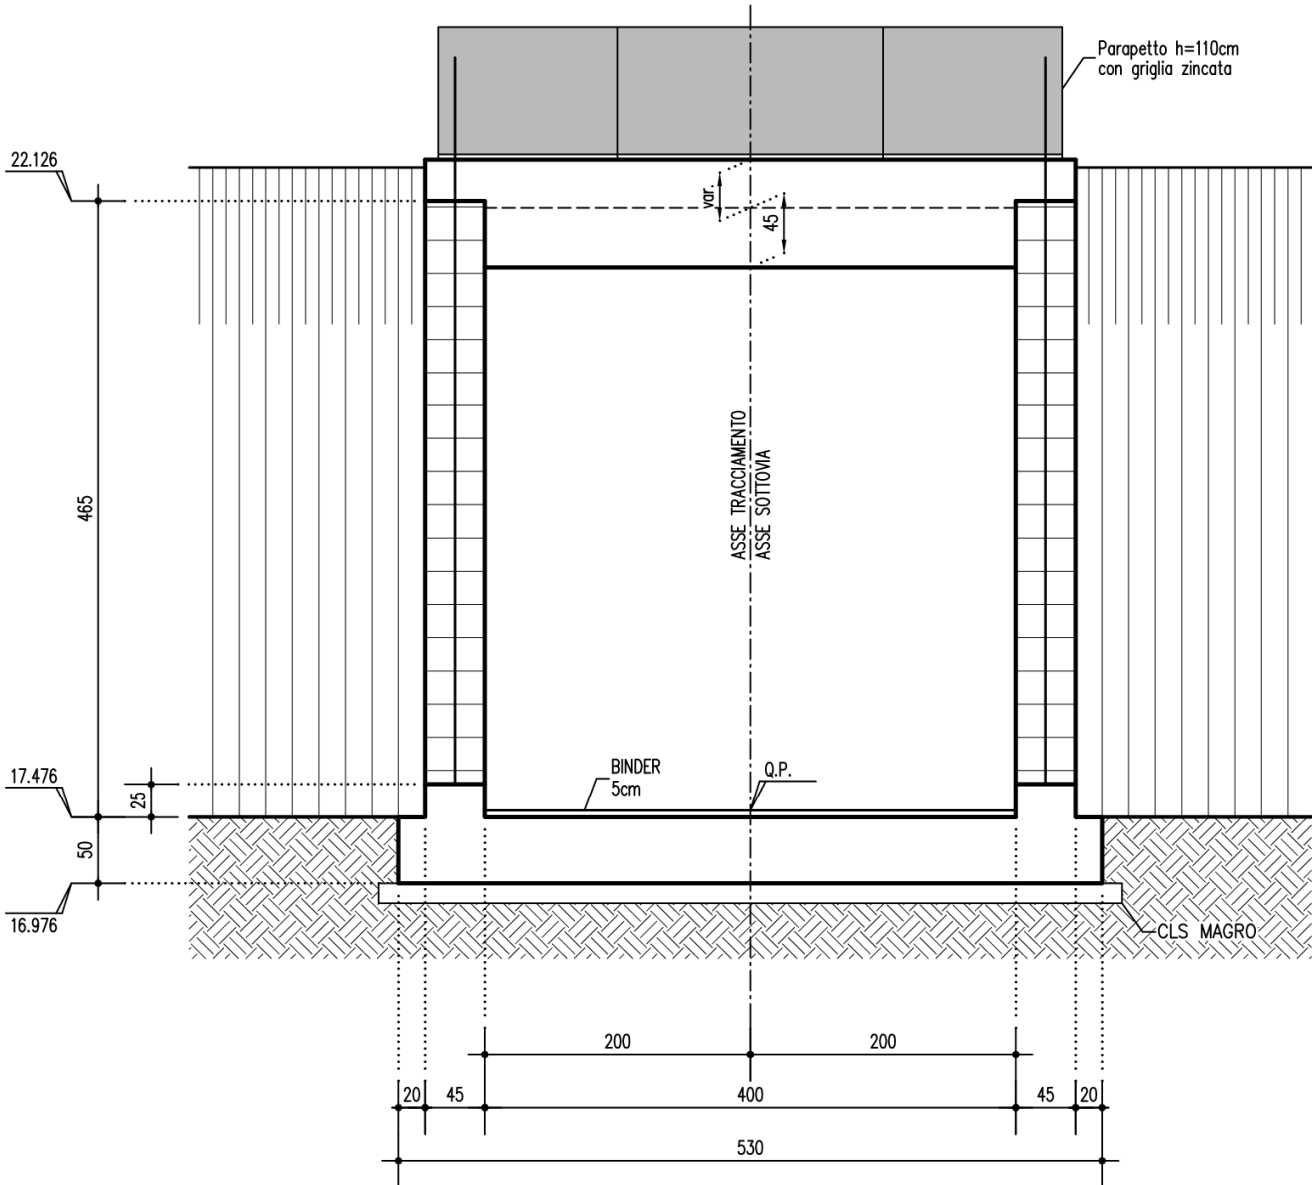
SEZIONE TRASVERSALE MURI AD U
